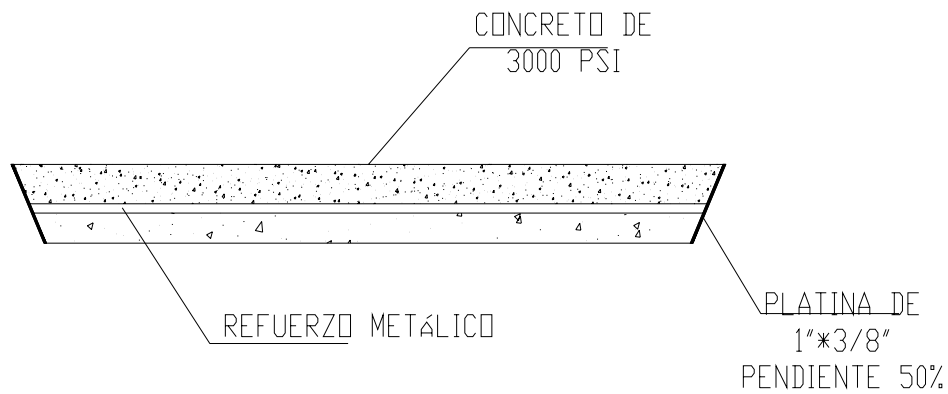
Tapa para caja de inspección MT. Vista lateral
